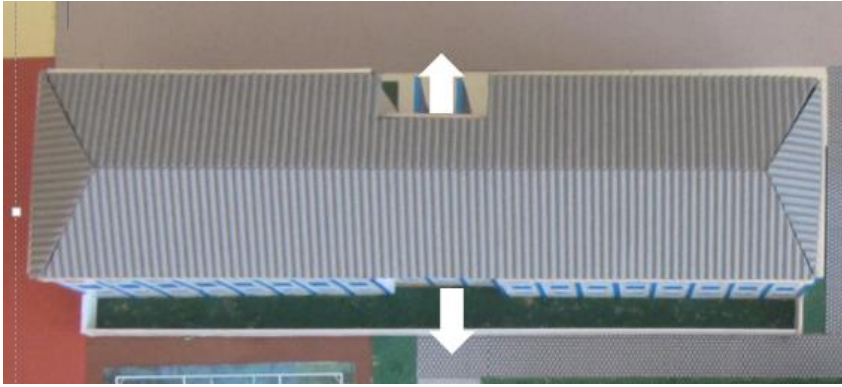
Ubicación cámaras exteriores del área de vivienda
